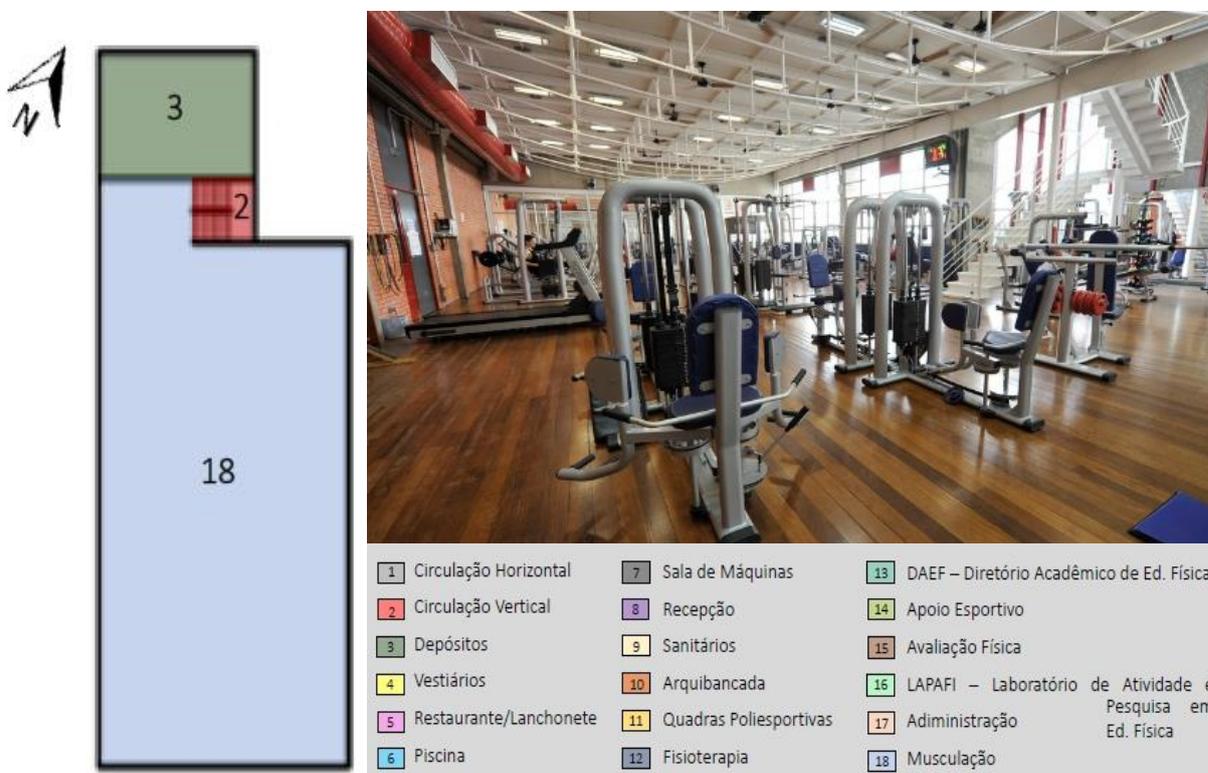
Planta baixa do 1º pavimento e academia de musculação.
